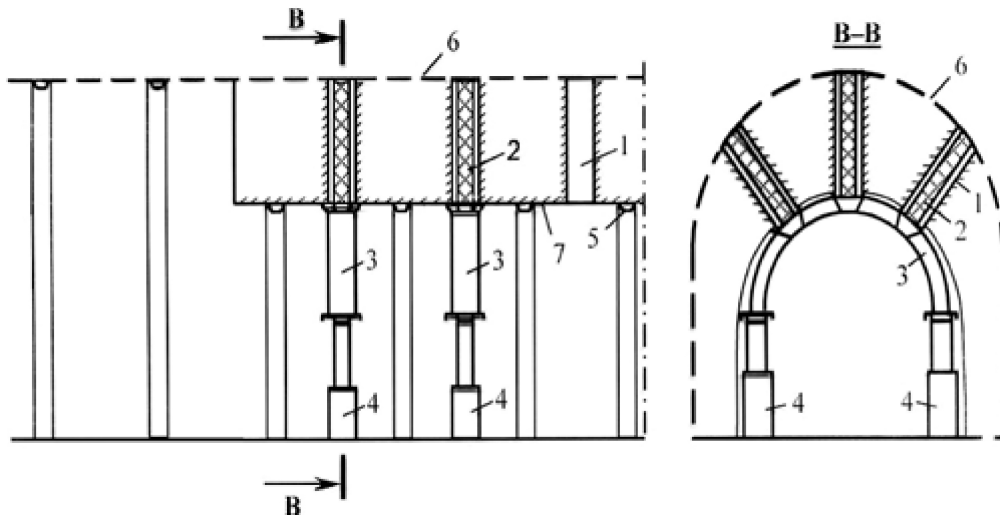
Способ перекрепления выработки: 1 – скважины; 2 – опорные элементы (закрепные стойки); 3 – арочный сегмент; 4 – стойки усиления; 5 – крепь выработки; 6 – проектный контур выработки; 7 – контур ремонтируемой выработки
